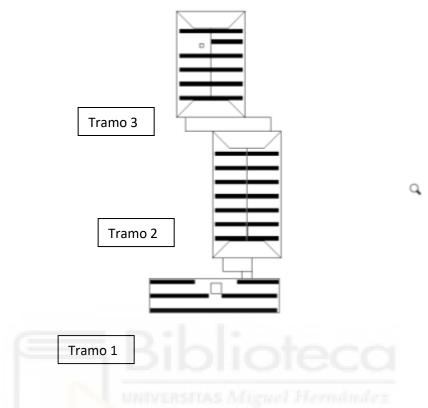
Vista planta paneles FV separación entre filas y obstáculos
